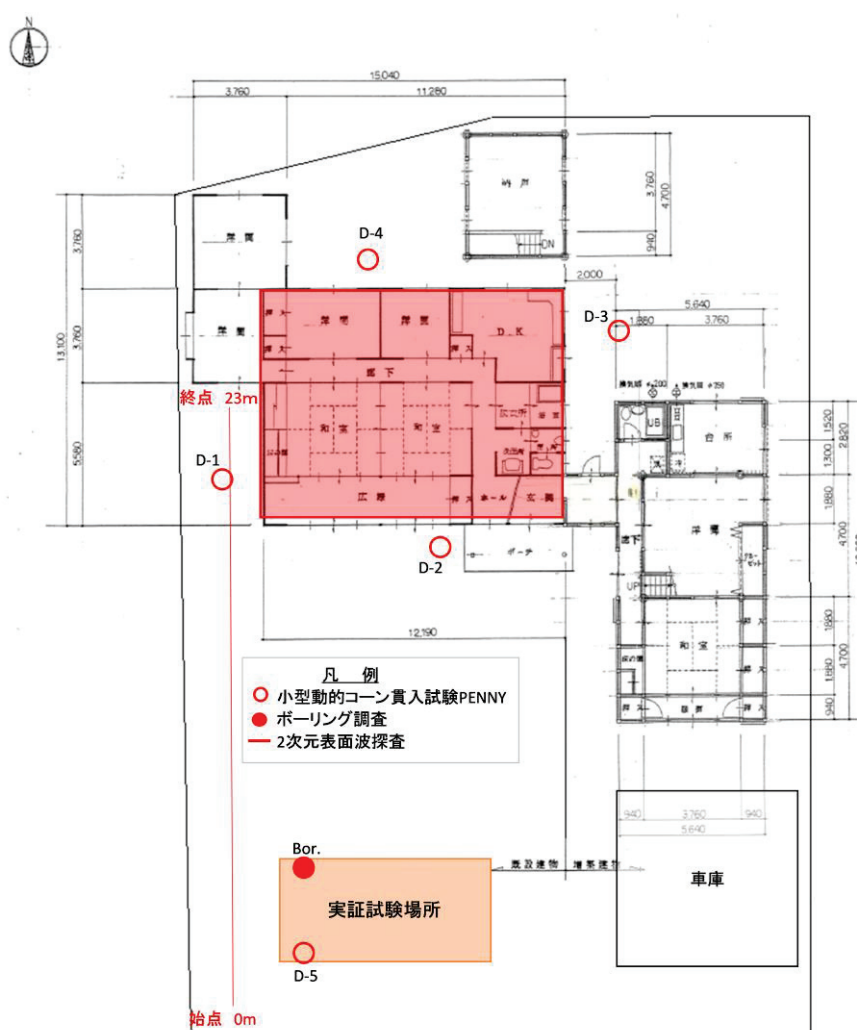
実証試験ならびに現場試験施工の敷地平面図
